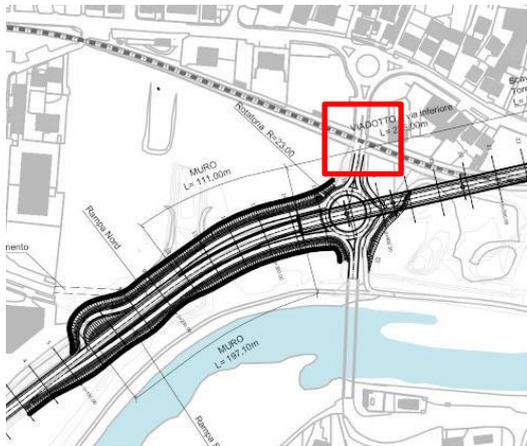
xii – Individuazione del PL ferroviario, soluzione progettuale B1 (senza rampa di immissione su via Stelvio da Tirano)
